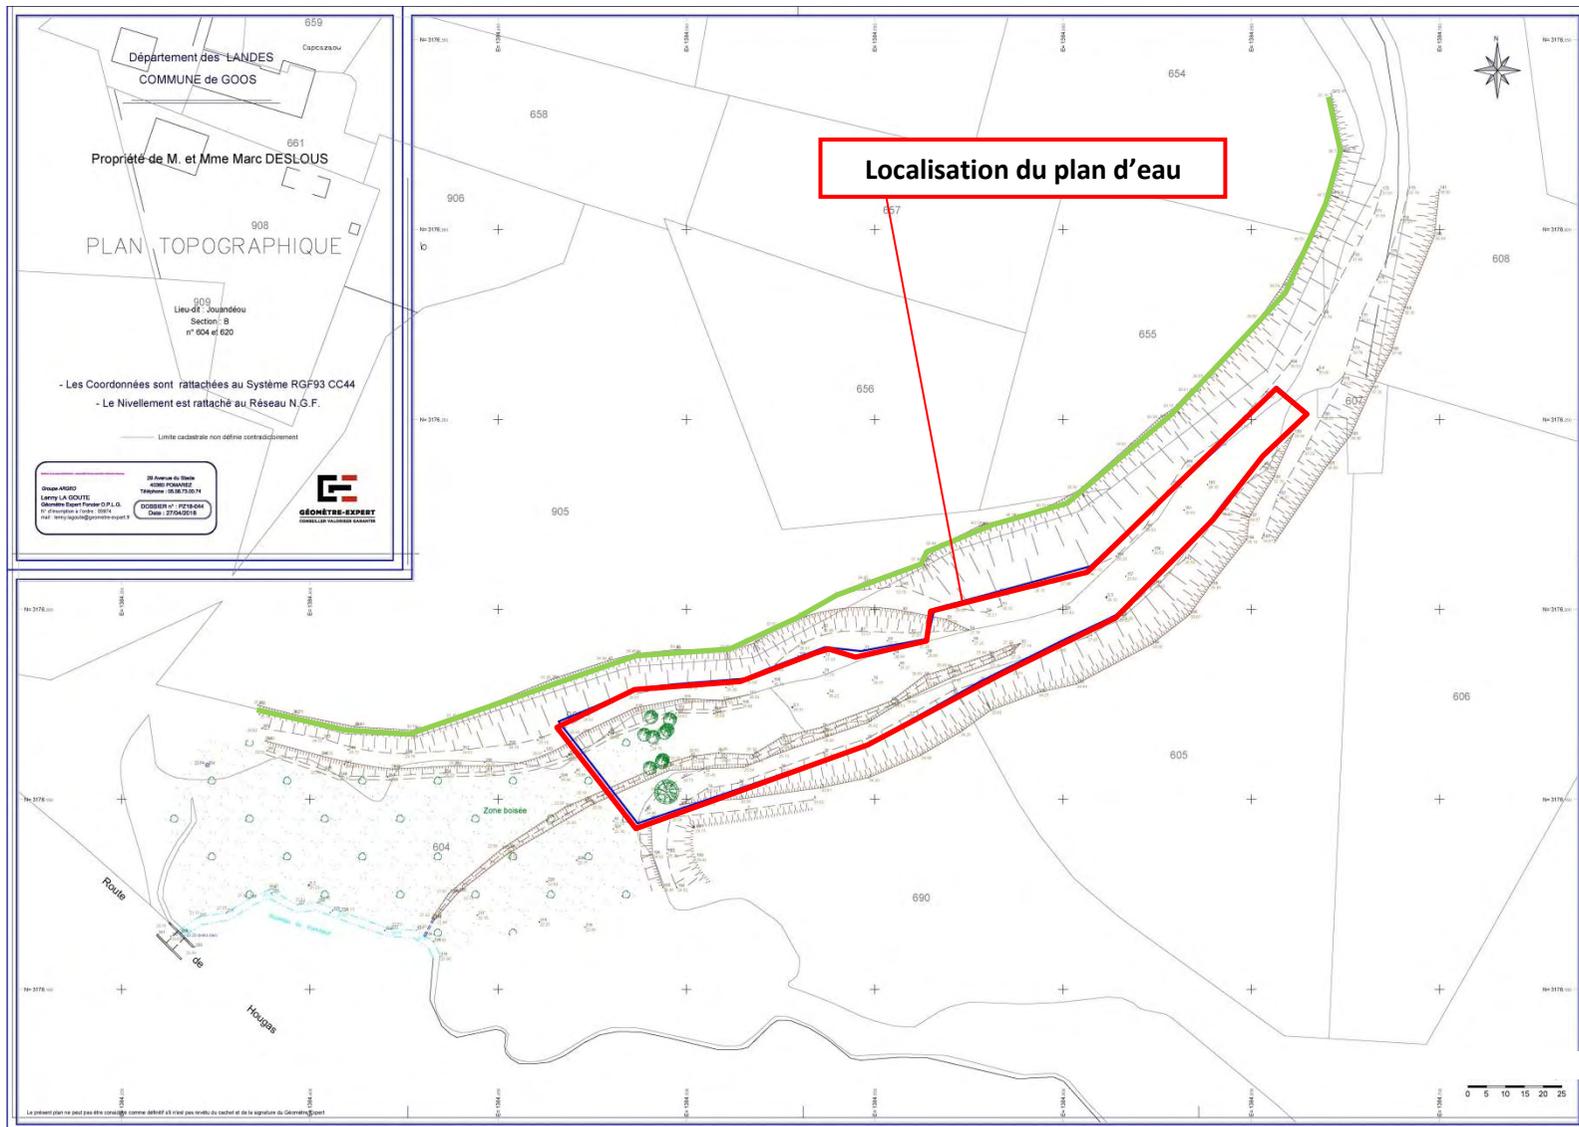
Plan topographique avec schéma du projet (avant-projet) échelle 1/2000
